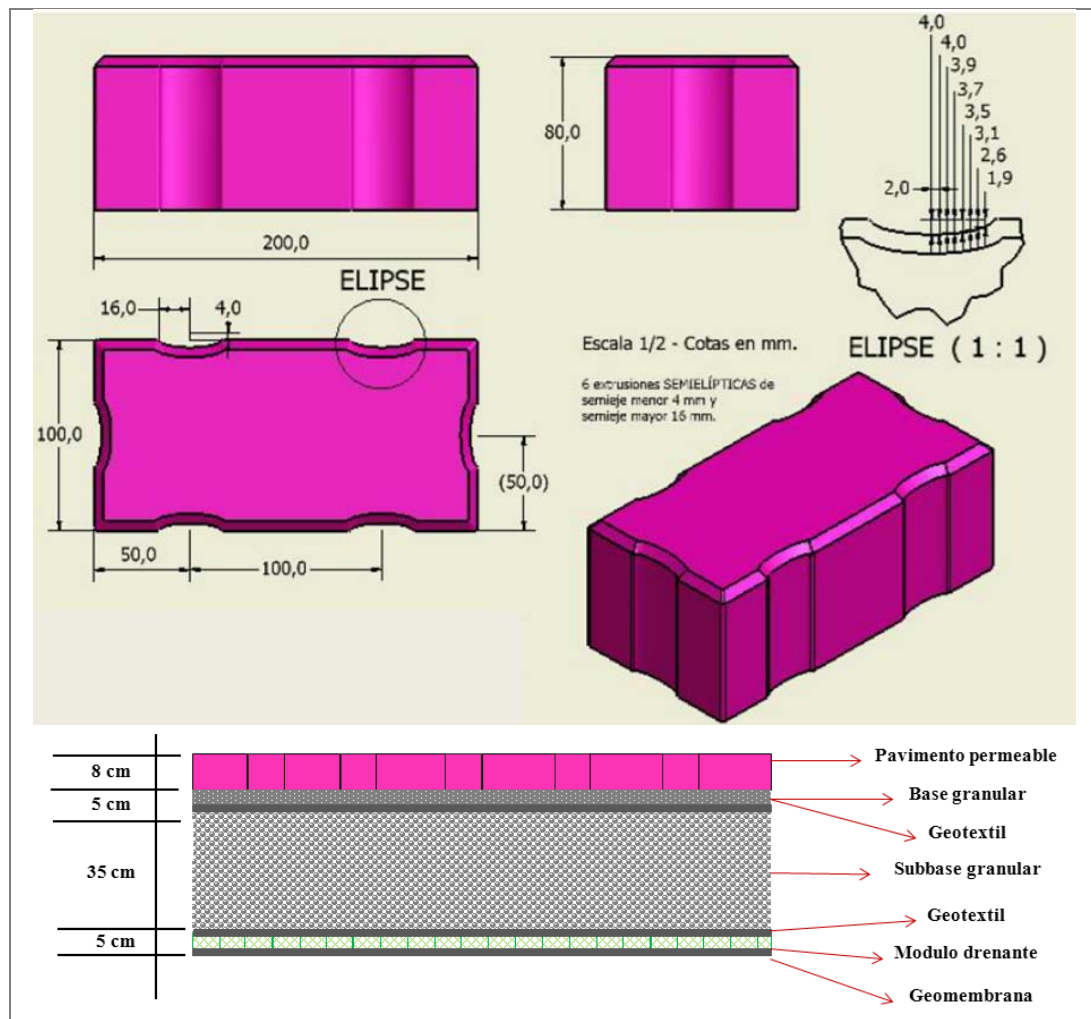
Vista en planta y perfil de adoquín “permeable”
